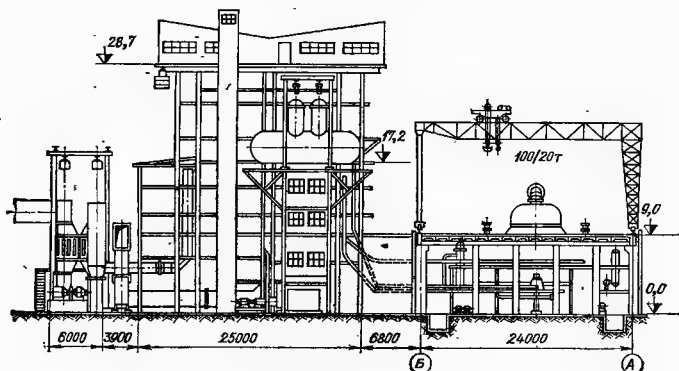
Поперечный разрез по главному корпусу ТЭС с открытой компоновкой
